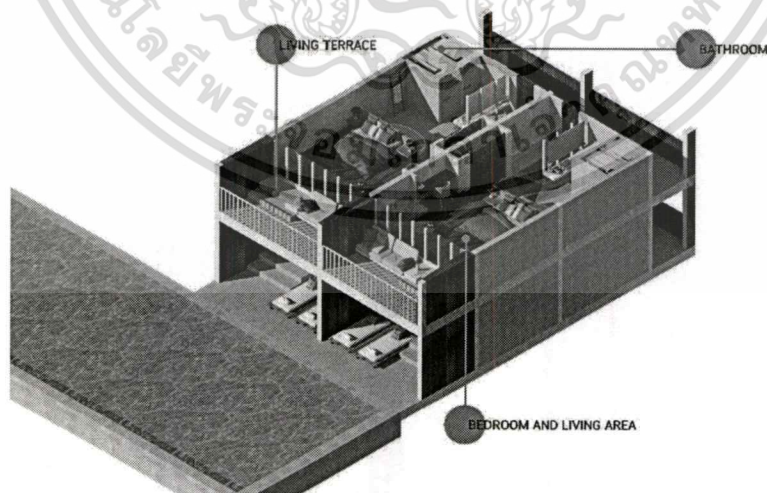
รูปตัดทั้งโครงการ Not To Scale
